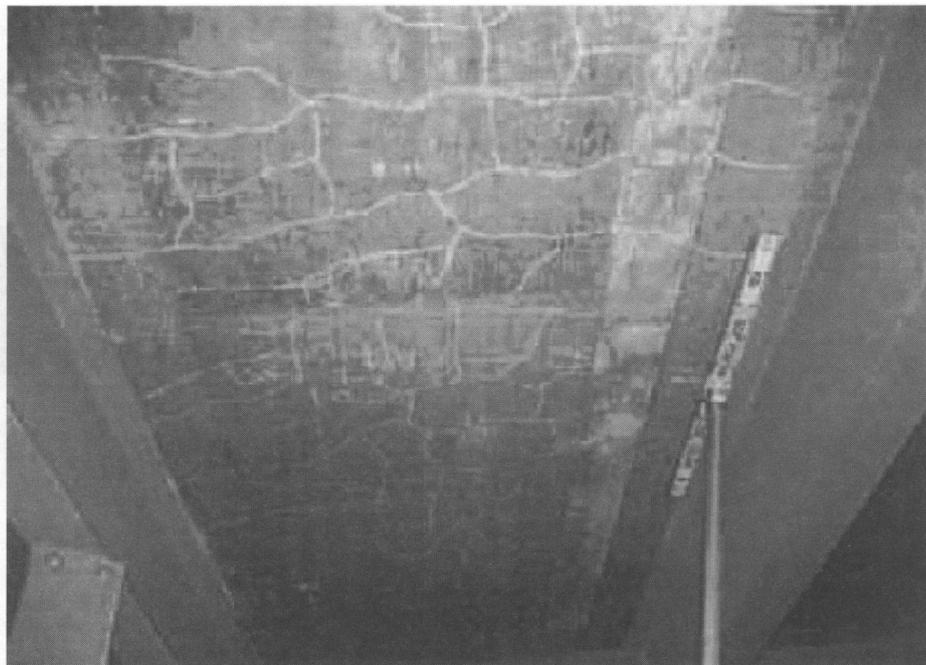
劣化度Ⅱの事例(床版のひび割れ, 橋梁上部構造)
